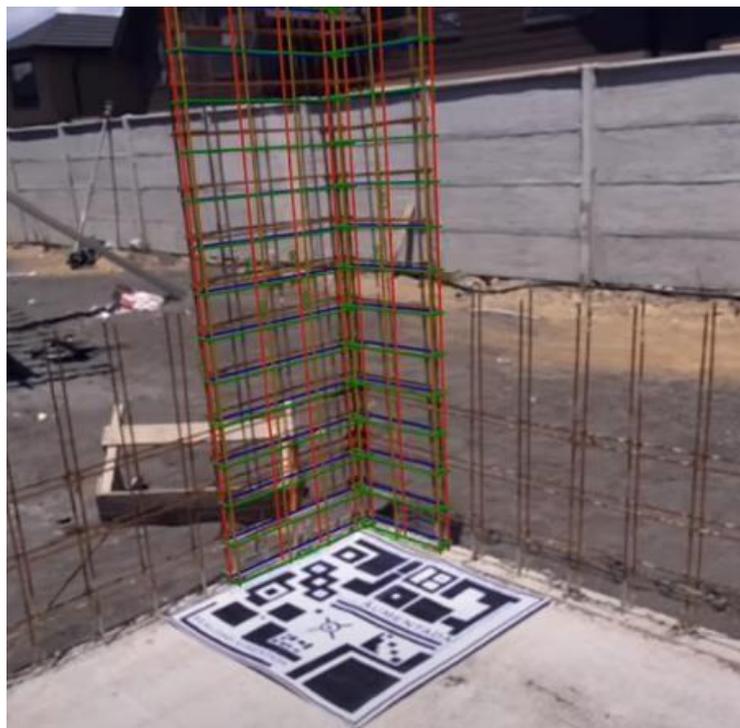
Comprobación de espaciamiento de aceros en columnas y placas
